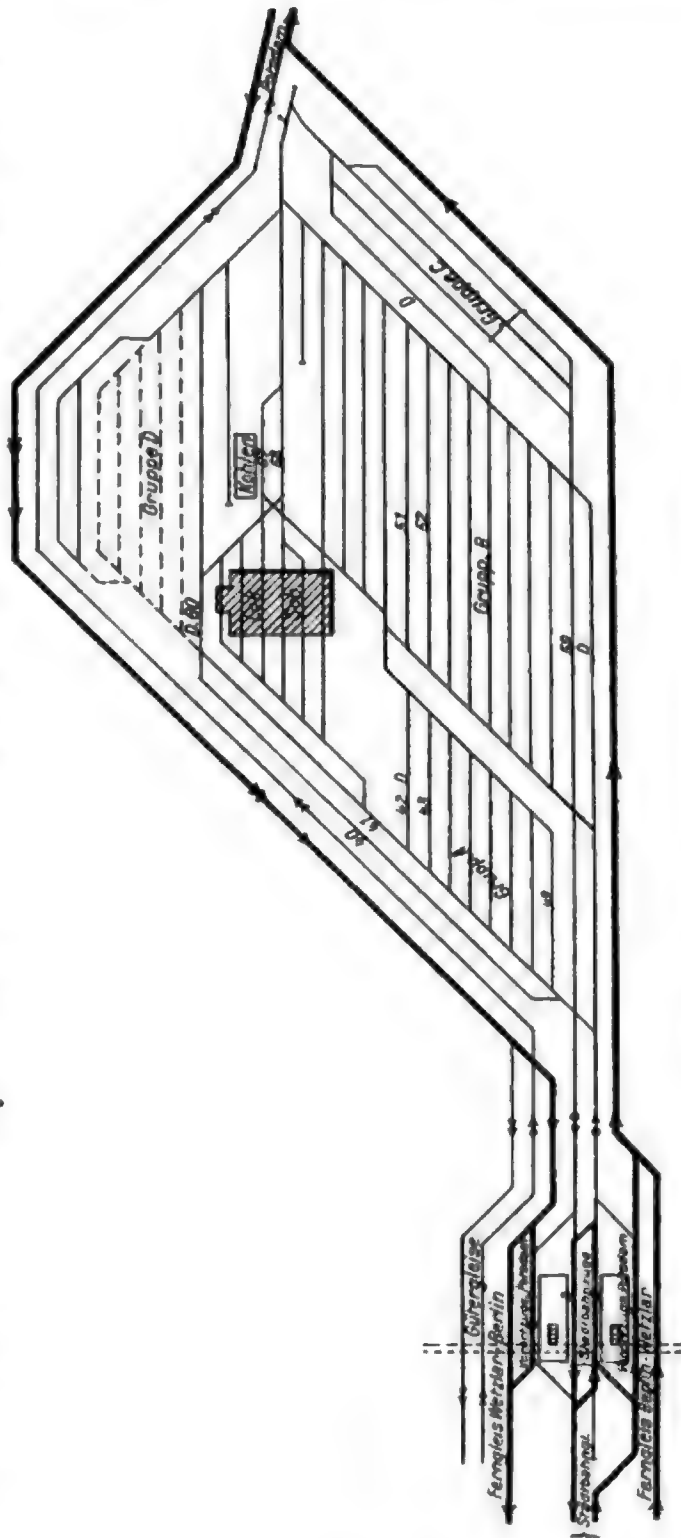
Abstellbahnhof Grunewald (Stadtbahn).
